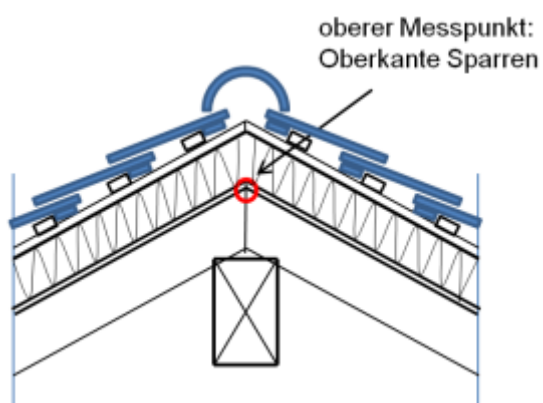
Dachquerschnitt. Alle Bauelemente oberhalb der Sparren (Dacheindeckung, Lattung/Konterlattung, Unterdach, ggf. Isolation oberhalb der Sparren) zählen nicht zur Dachkonstruktion (Quelle: Leitfaden zur Harmonisierung der Baubegriffe vom 1. März 2017)
